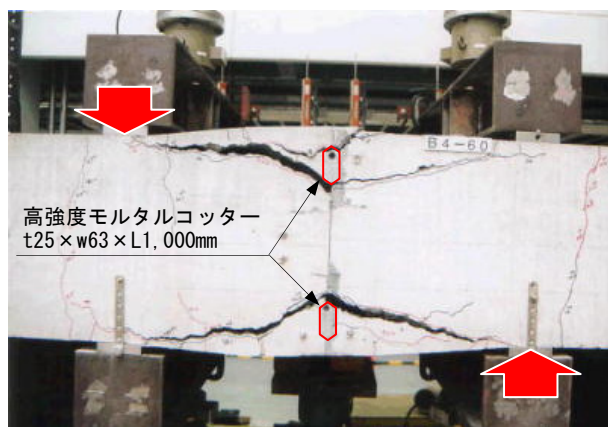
ひび割れ発生状況 (δ = -6mm)
